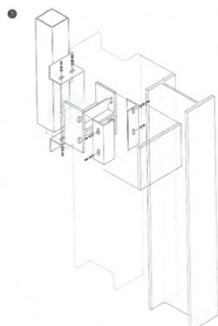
Nudo entre la cubierta y soporte de fachada (cangrejo).
